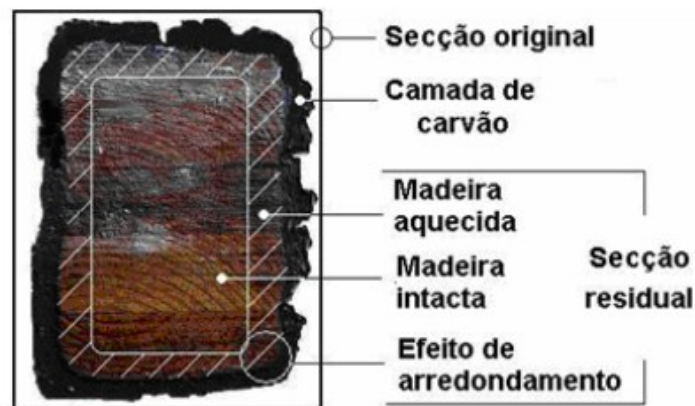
Secção transversal de um elemento sujeita ao fogo (Tecverde 2011).
